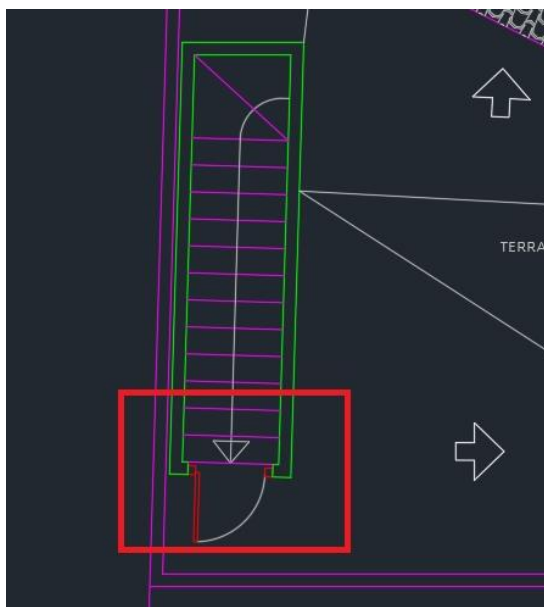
Planta. Fuente: Proyecto de ejecución (2011)
